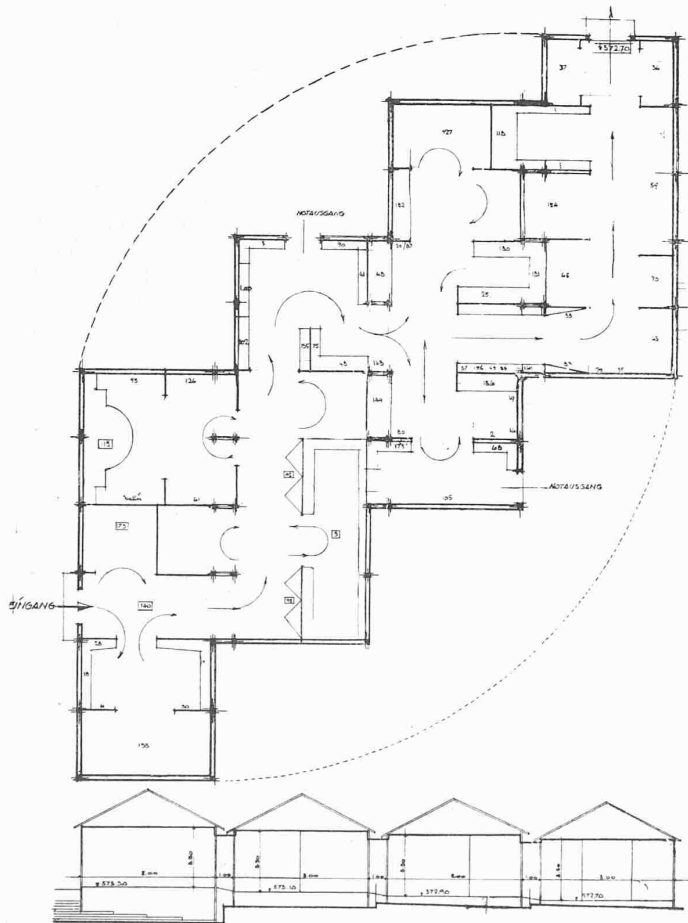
Grundriss und Schnitt einer Hallengruppe. — 1:400.
